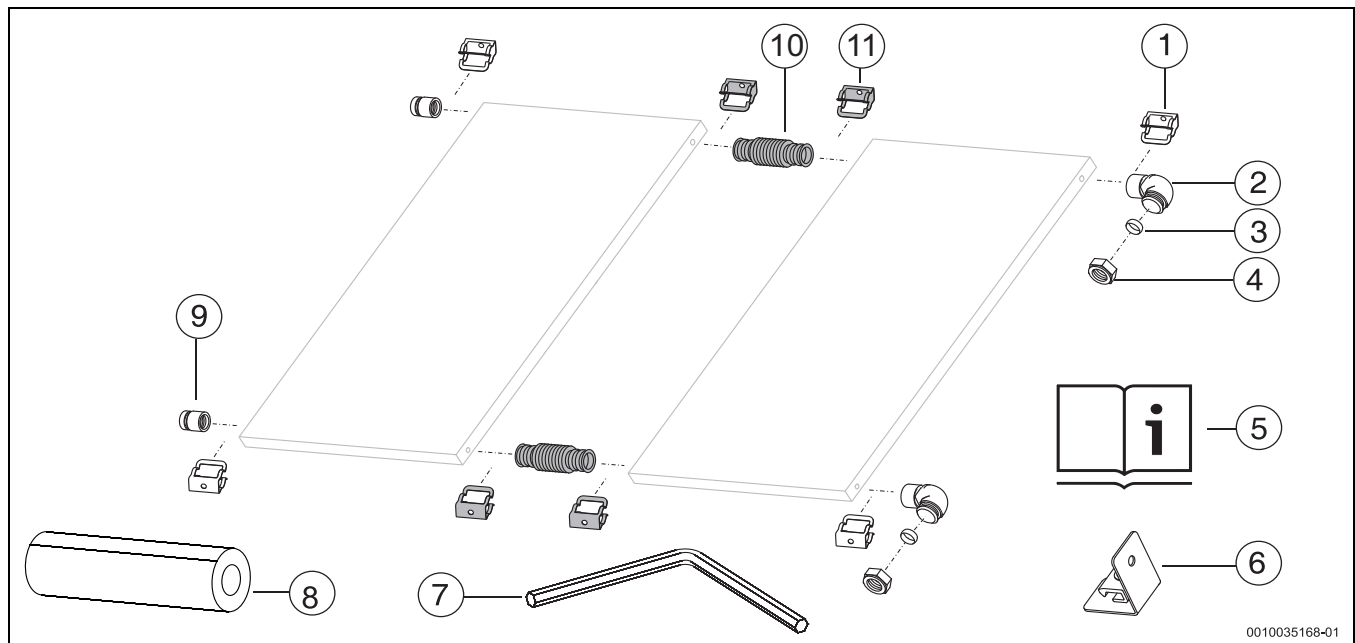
1 juego de piezas de conexión sobre el tejado plano y 2 juegos de piezas de conexión (gris)
